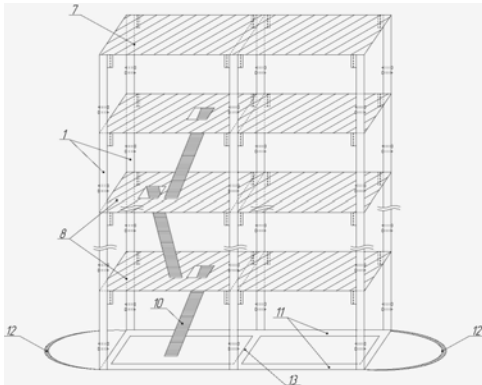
Загальний вид запобіжної пересувної вишки: 1 - опори; 7 - захисний помст; 8 - монтажні помсти; 10 - драбина; 11 - лижі; 12 - петля; 13 - повздовжня перемичка
